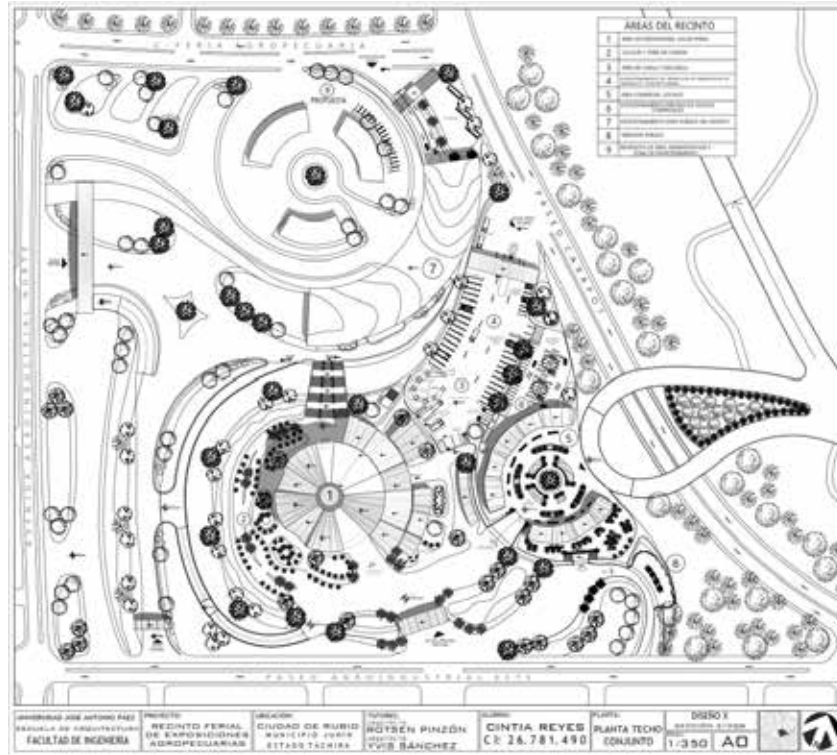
Plano A0, planta techo conjunto. La Autora (2020).
